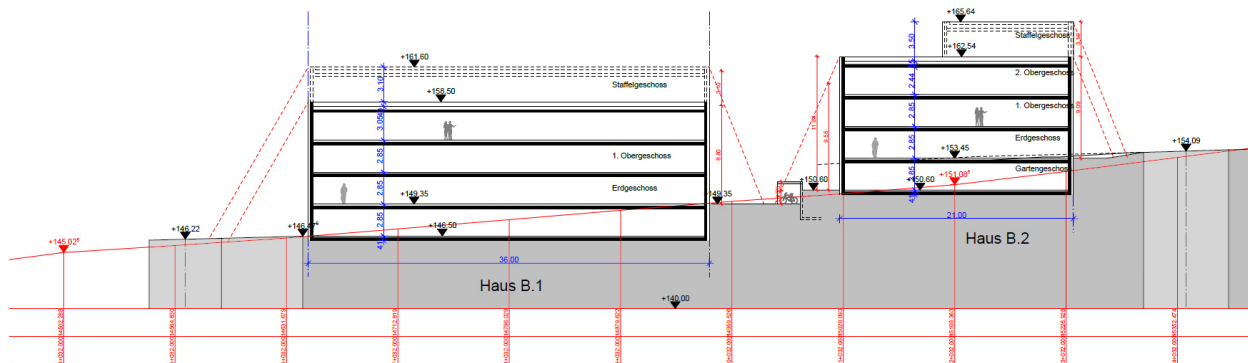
Schnitt zweier Gebäude in Baufeld B
